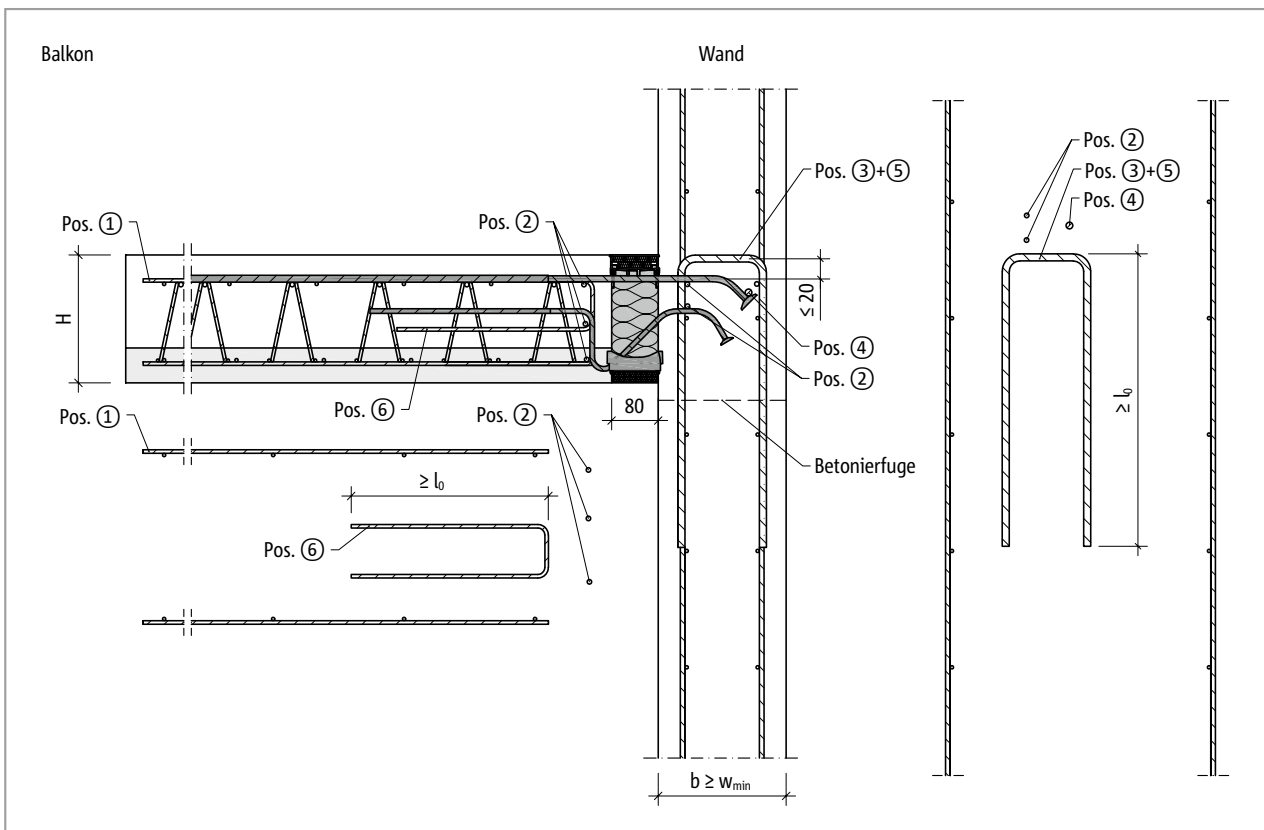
Schöck Isokorb® T Typ K-O-F: Bauseitige Bewehrung für Wandanschluss nach unten
